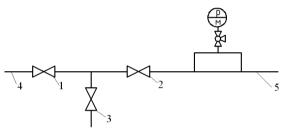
Схема для подачи воды от водопровода при испытании системы гидростатическим методом: 1, 2, 3 – вентили или шаровые краны; 4 – трубопровод от водопровода; 5 – трубопровод к системе отопления.
